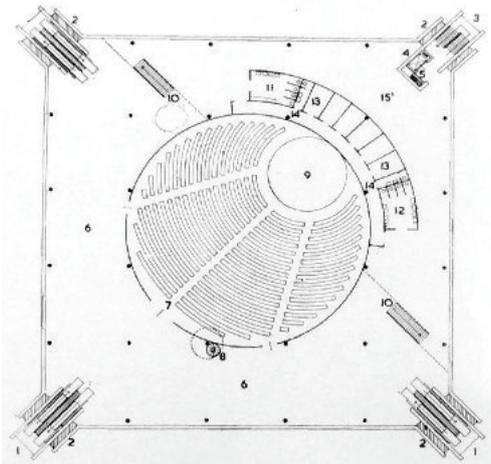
Planta de la propuesta para el Pabellón Español de José María García de Paredes.
